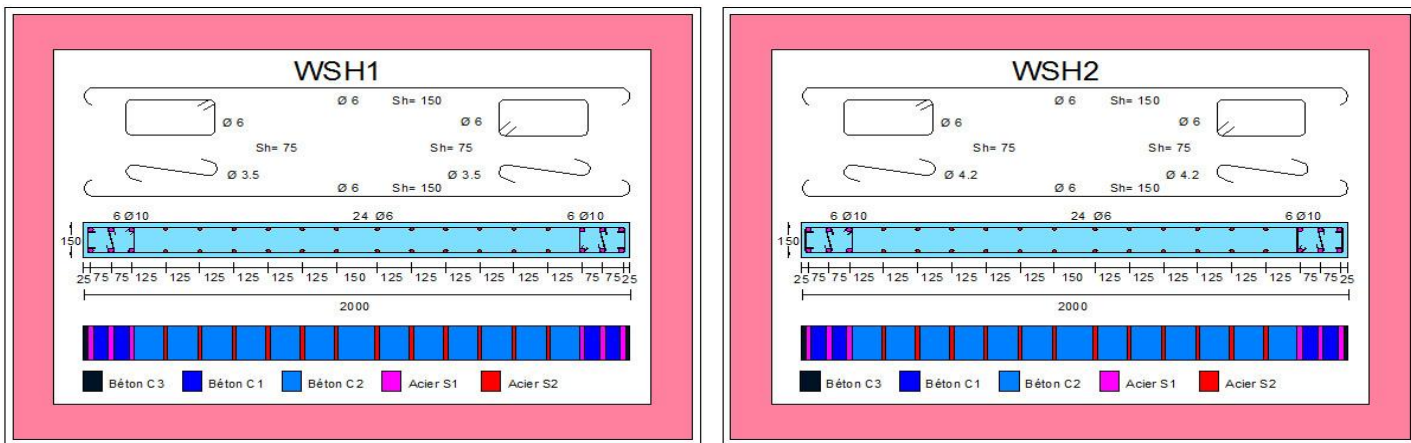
Ferrailage des parois WSH1 et WSH2 : discrétisation multicouche dimensions en mm
